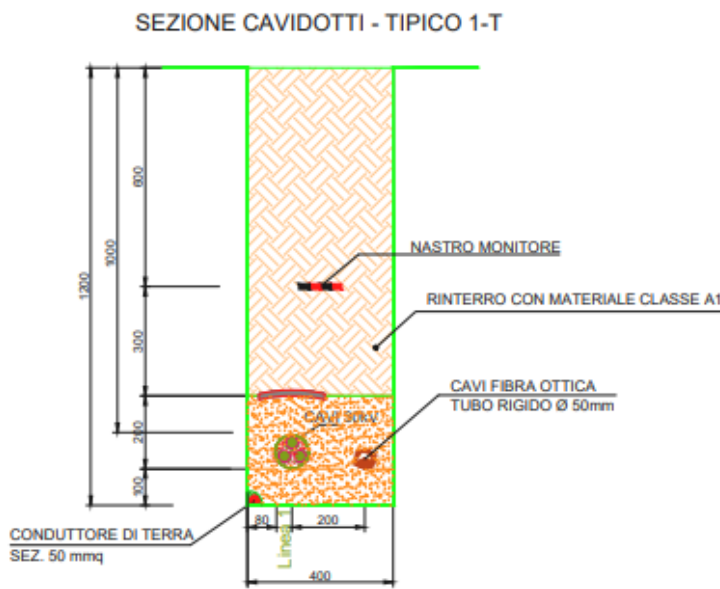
Sezione di scavo Cavo MT + cavo segnale e corda di rame su terreno
